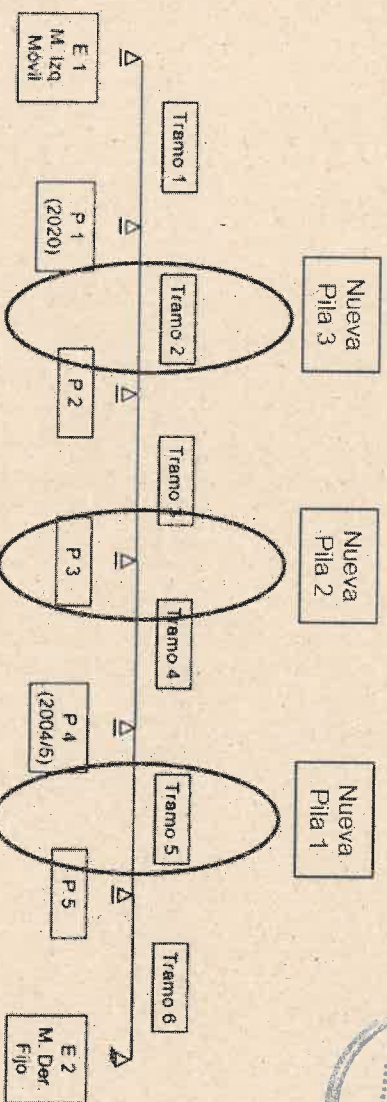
Esquema Estático de Puente Demolido y Emplazamiento de Pilas Nuevas con cuatro Tramos Iguales
